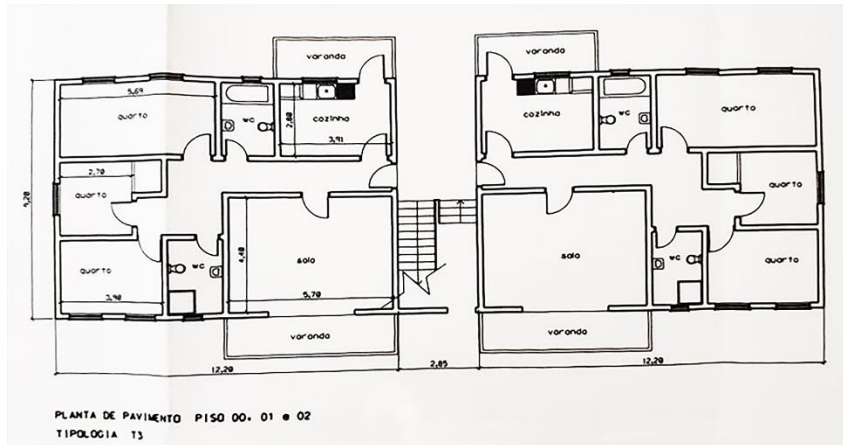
Planta dos pisos 0, 1 e 2 do projeto idealizado para execução em Bombom e Conde. Desenho facultado pelo IHI
